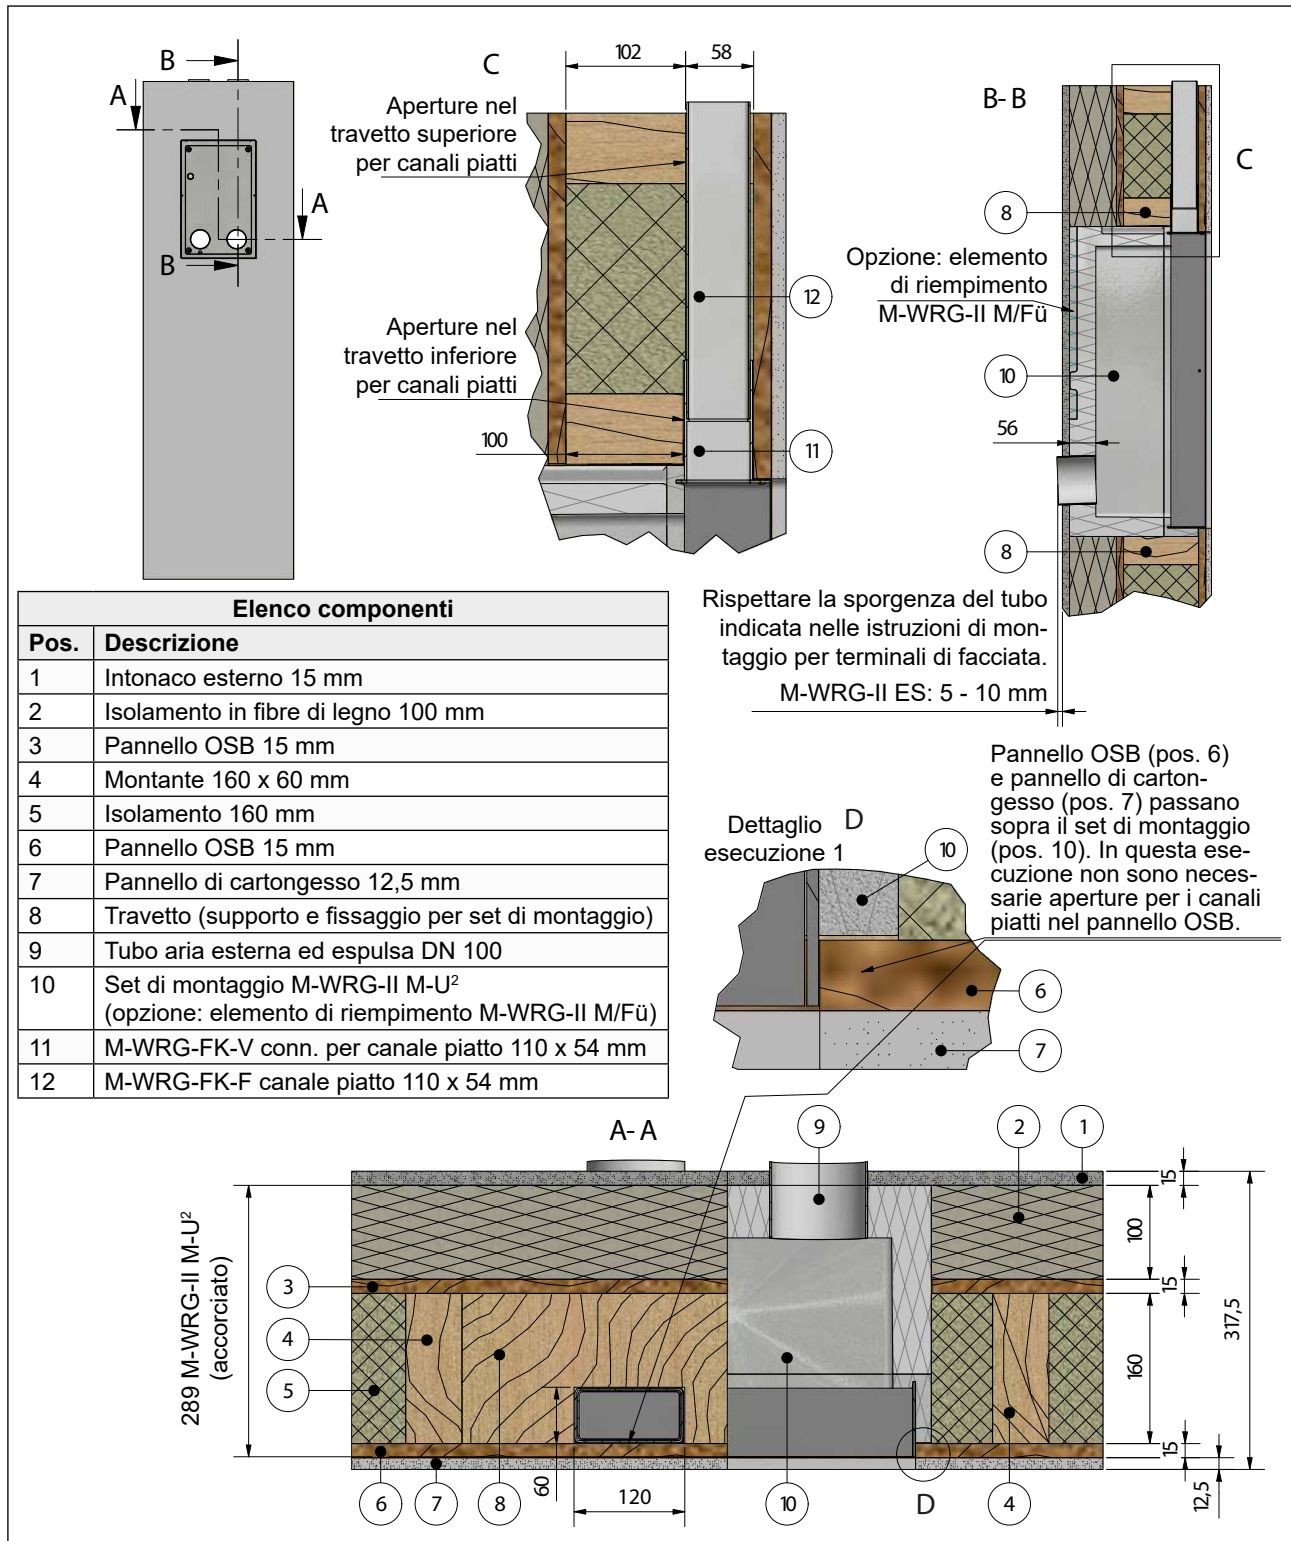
Esempio di progettazione per l'installazione del set di montaggio in una costruzione con montanti con spessore dei montanti di 160 mm
